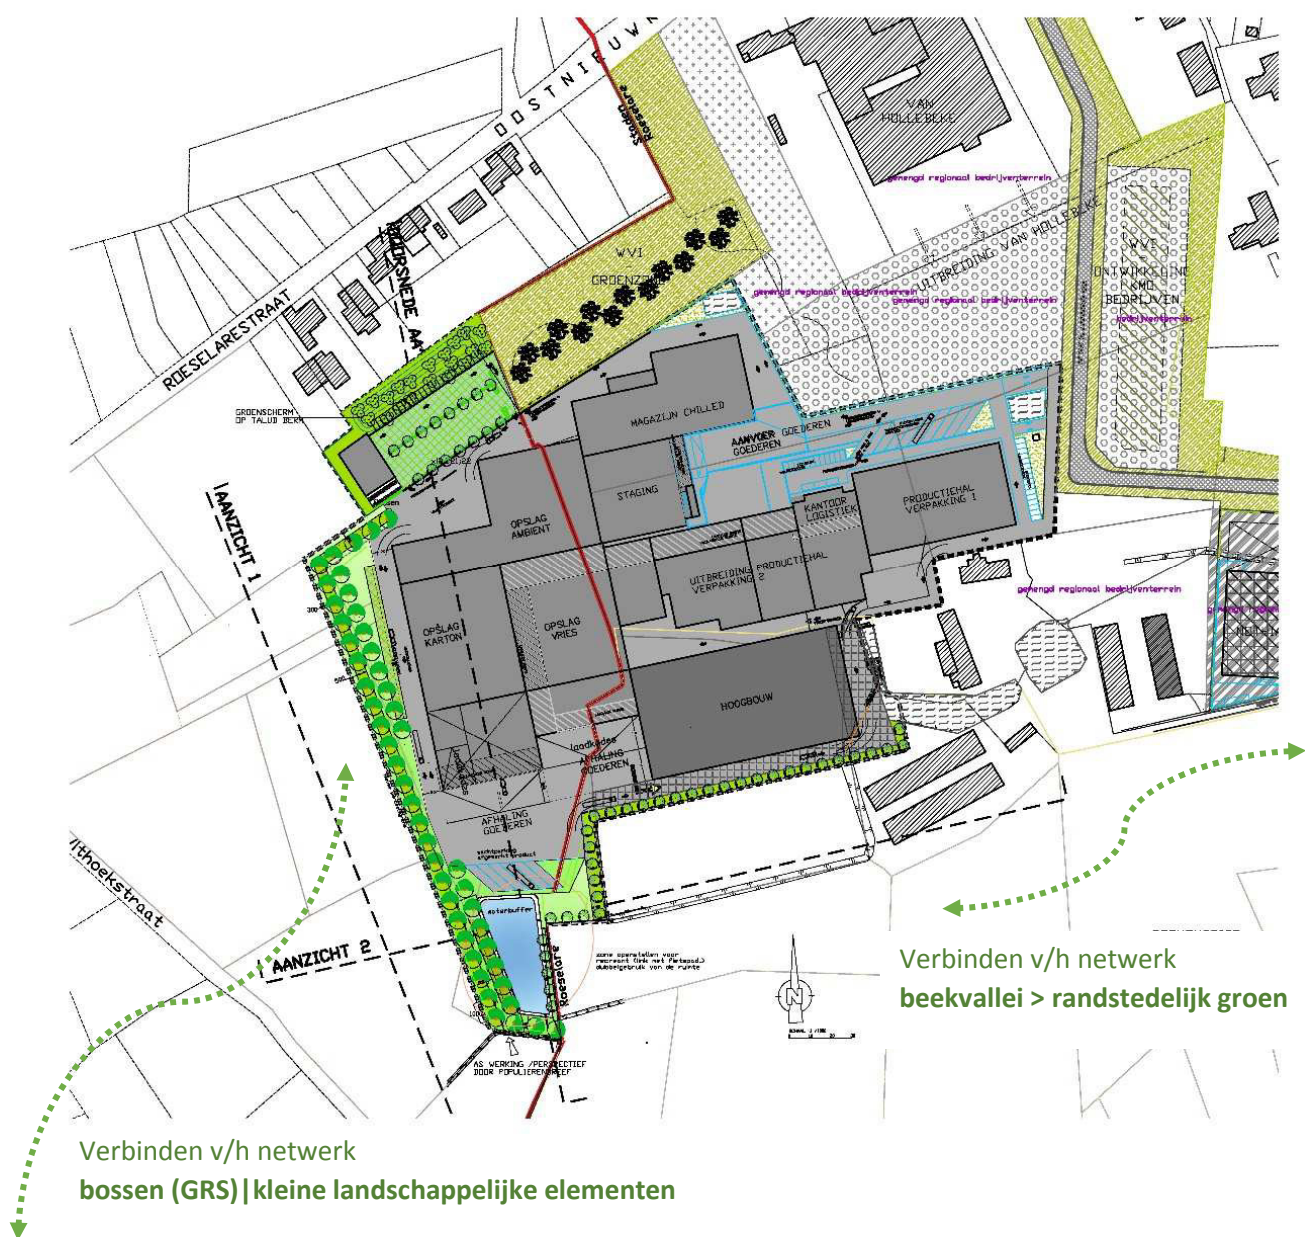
/ Gewenste ruimtelijke structuur (+ aanduiding plangebied)
